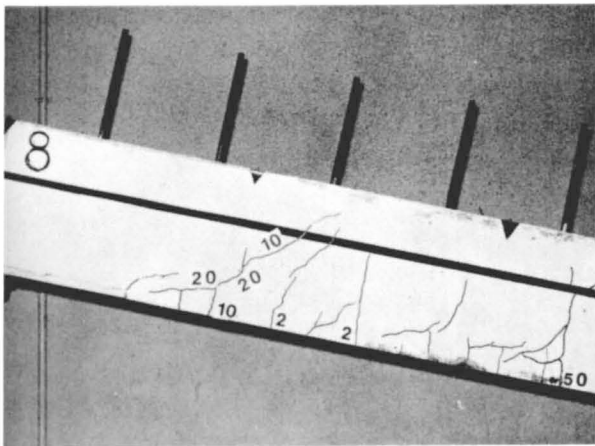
Detailaufnahmen nach Versuch B8.3
